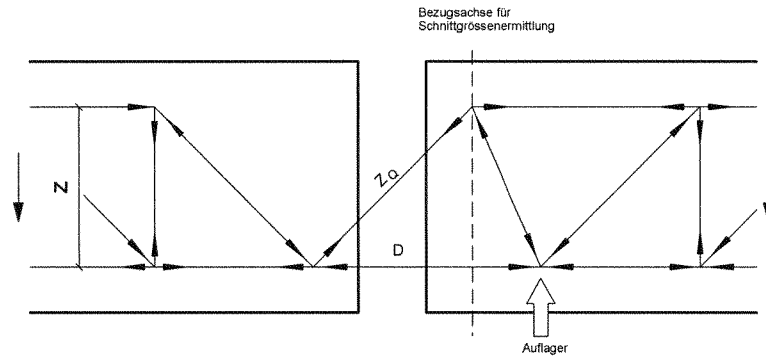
egcobox Plattenelement Fachwerkmodell Typ PV; PV-D; PV-DD
